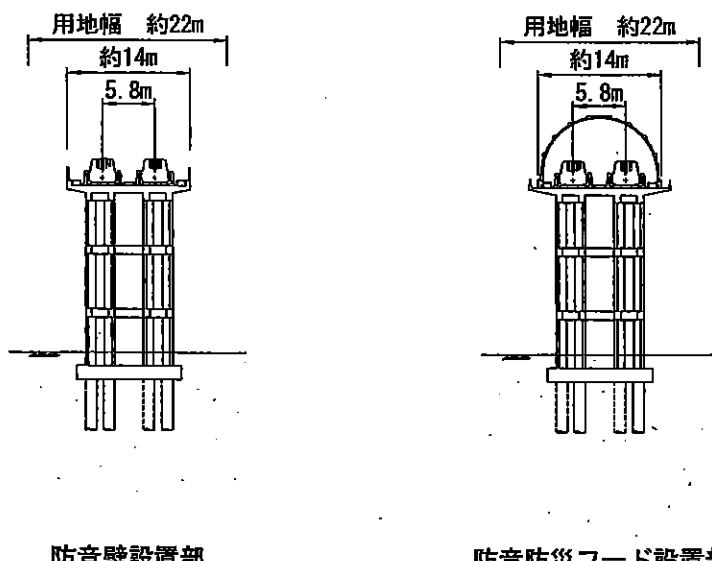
標準的な高架橋（新形式高架橋）の断面図
